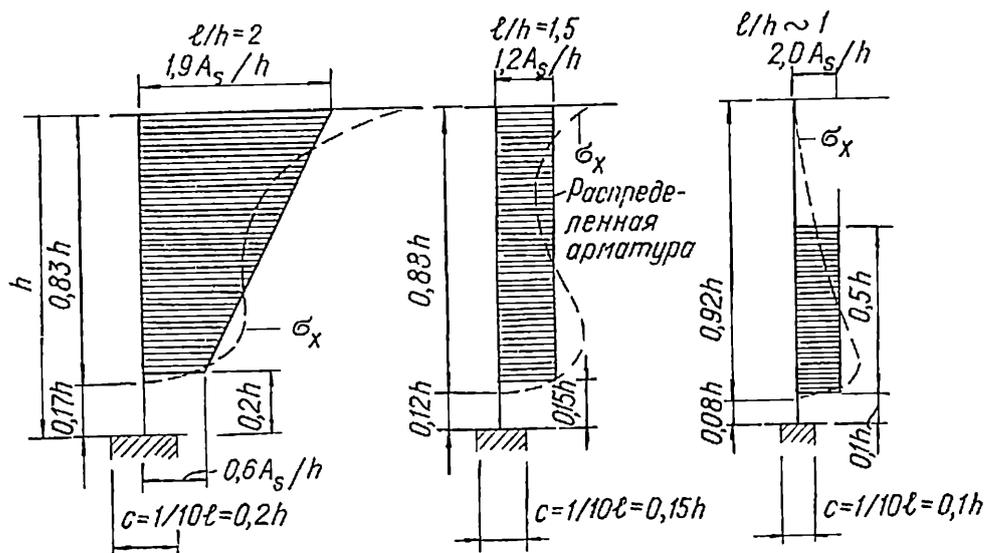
5. Указание по распределению растянутой арматуры над опорами многопролетной балки-стенки
